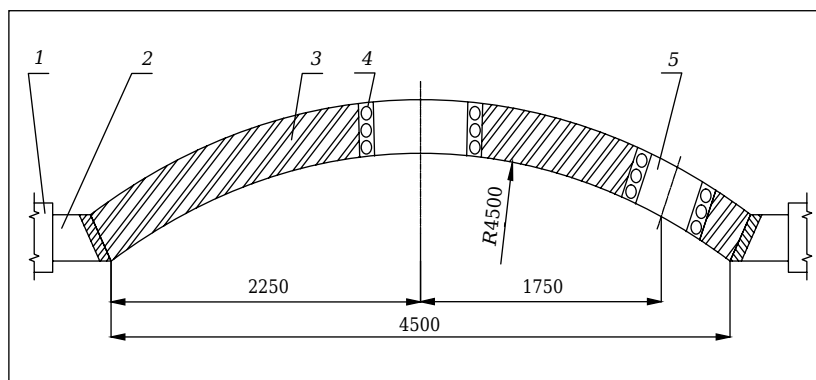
Схема футеровки арочного свода кивцэтного агрегата: 1 — боковая пружина; 2 — пятая балка; 3 — футеровочный слой; 4 — кессон электродного отверстия; 5 — кессонированное загрузочное отверстие
